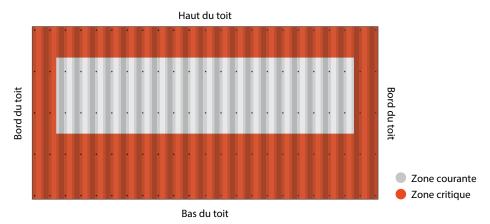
Exemples de zones où disposer les pontets pour une toiture à un ou deux versants
